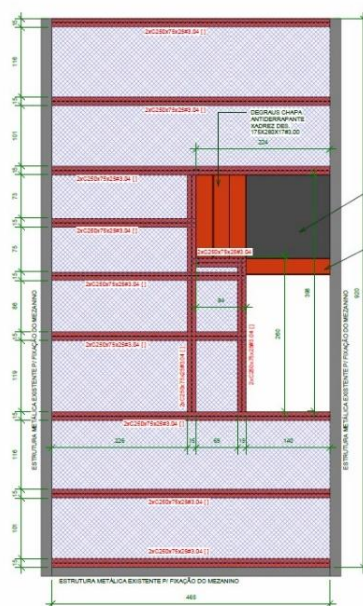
Vista superior do vigamento do mezanino (planta estrutural). Fonte: Projeto Eng^o Civil Vinicius Ornelas (2025).
